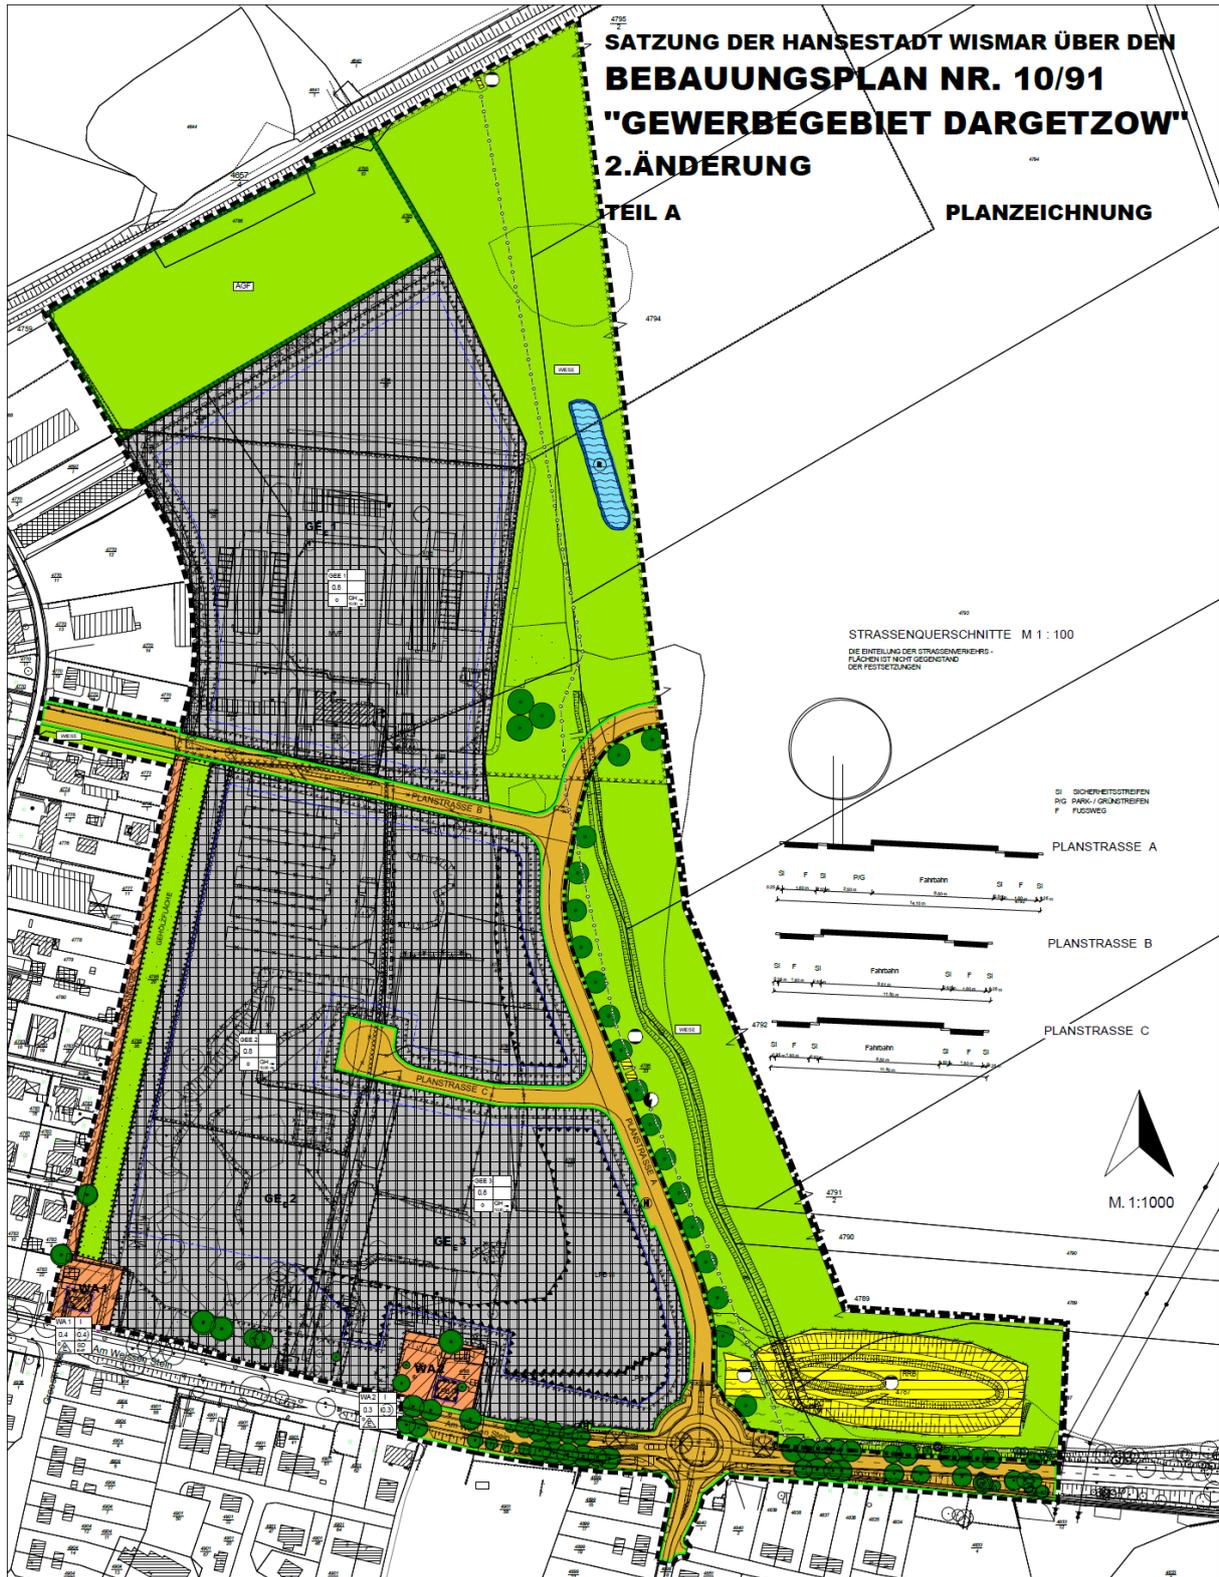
Planzeichnung 2. Änd. B-Plan Nr. 10/91, Stand: Sept. 2012.
